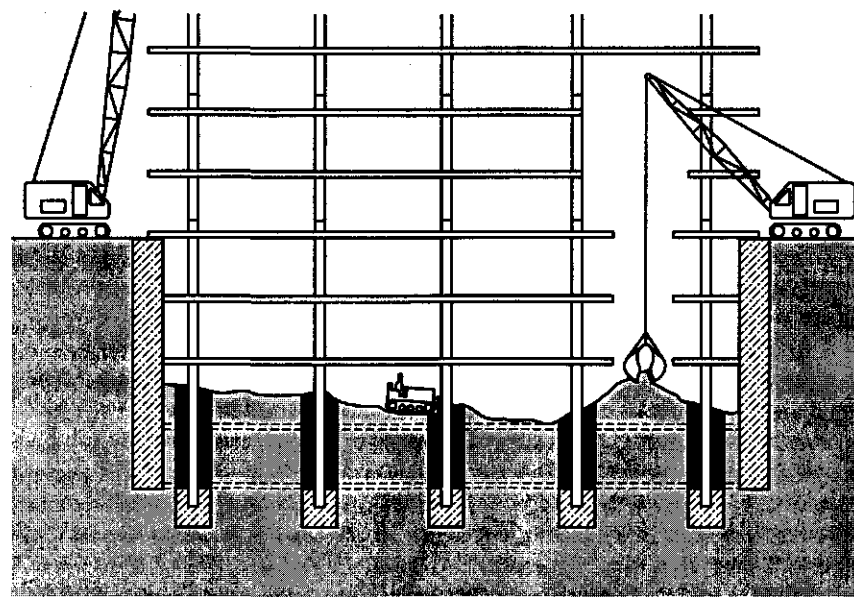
Разработка грунта внутри заглубленного сооружения, возводимого методом «стена в грунте»
